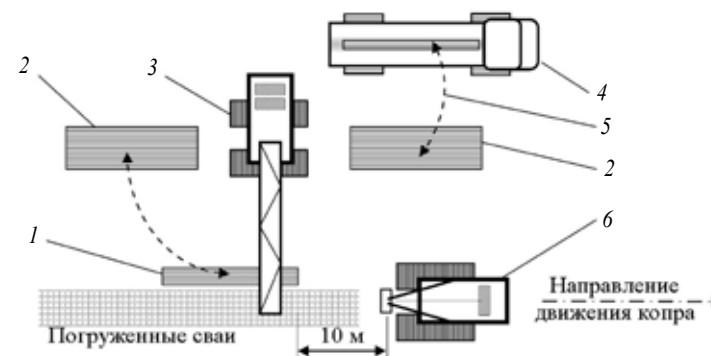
План-схема организации работ забивки свай: 1 – сваи, разложенные к подаче на копер; 2 – штабель свай на прокладках; 3 – гусеничный кран; 4 – автотранспорт доставки свай; 5 – траектория перемещения свай краном; 6 – копер
